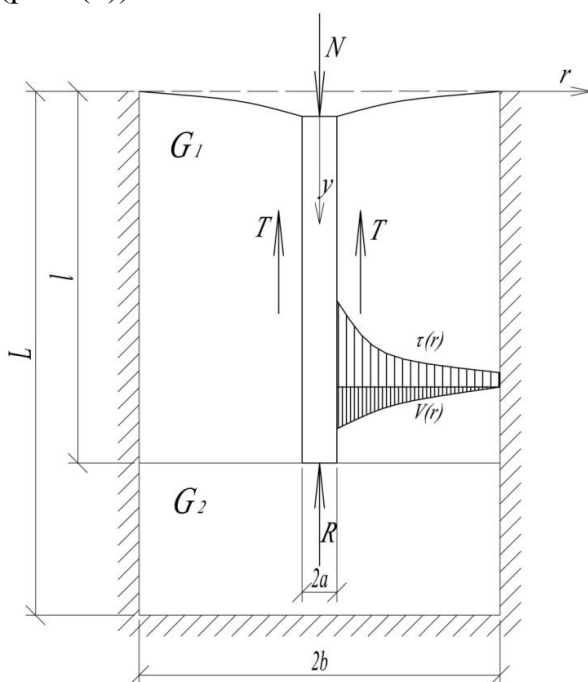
Расчетная схема взаимодействия абсолютно жесткой сваи с двухслойным грунтовым основанием
